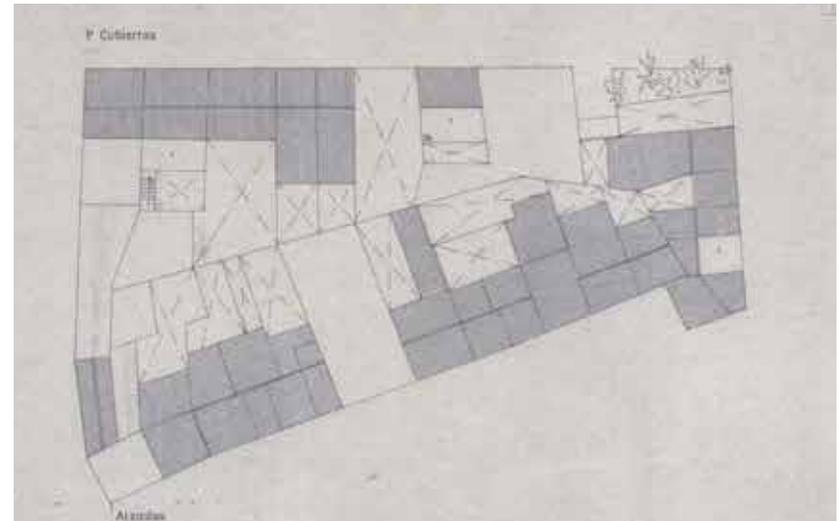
Planta de cubierta. Estudio de Manzana - NNS, plano IV.1.4.2. Fuente: Ayuntamiento de Gaucín, 1986
